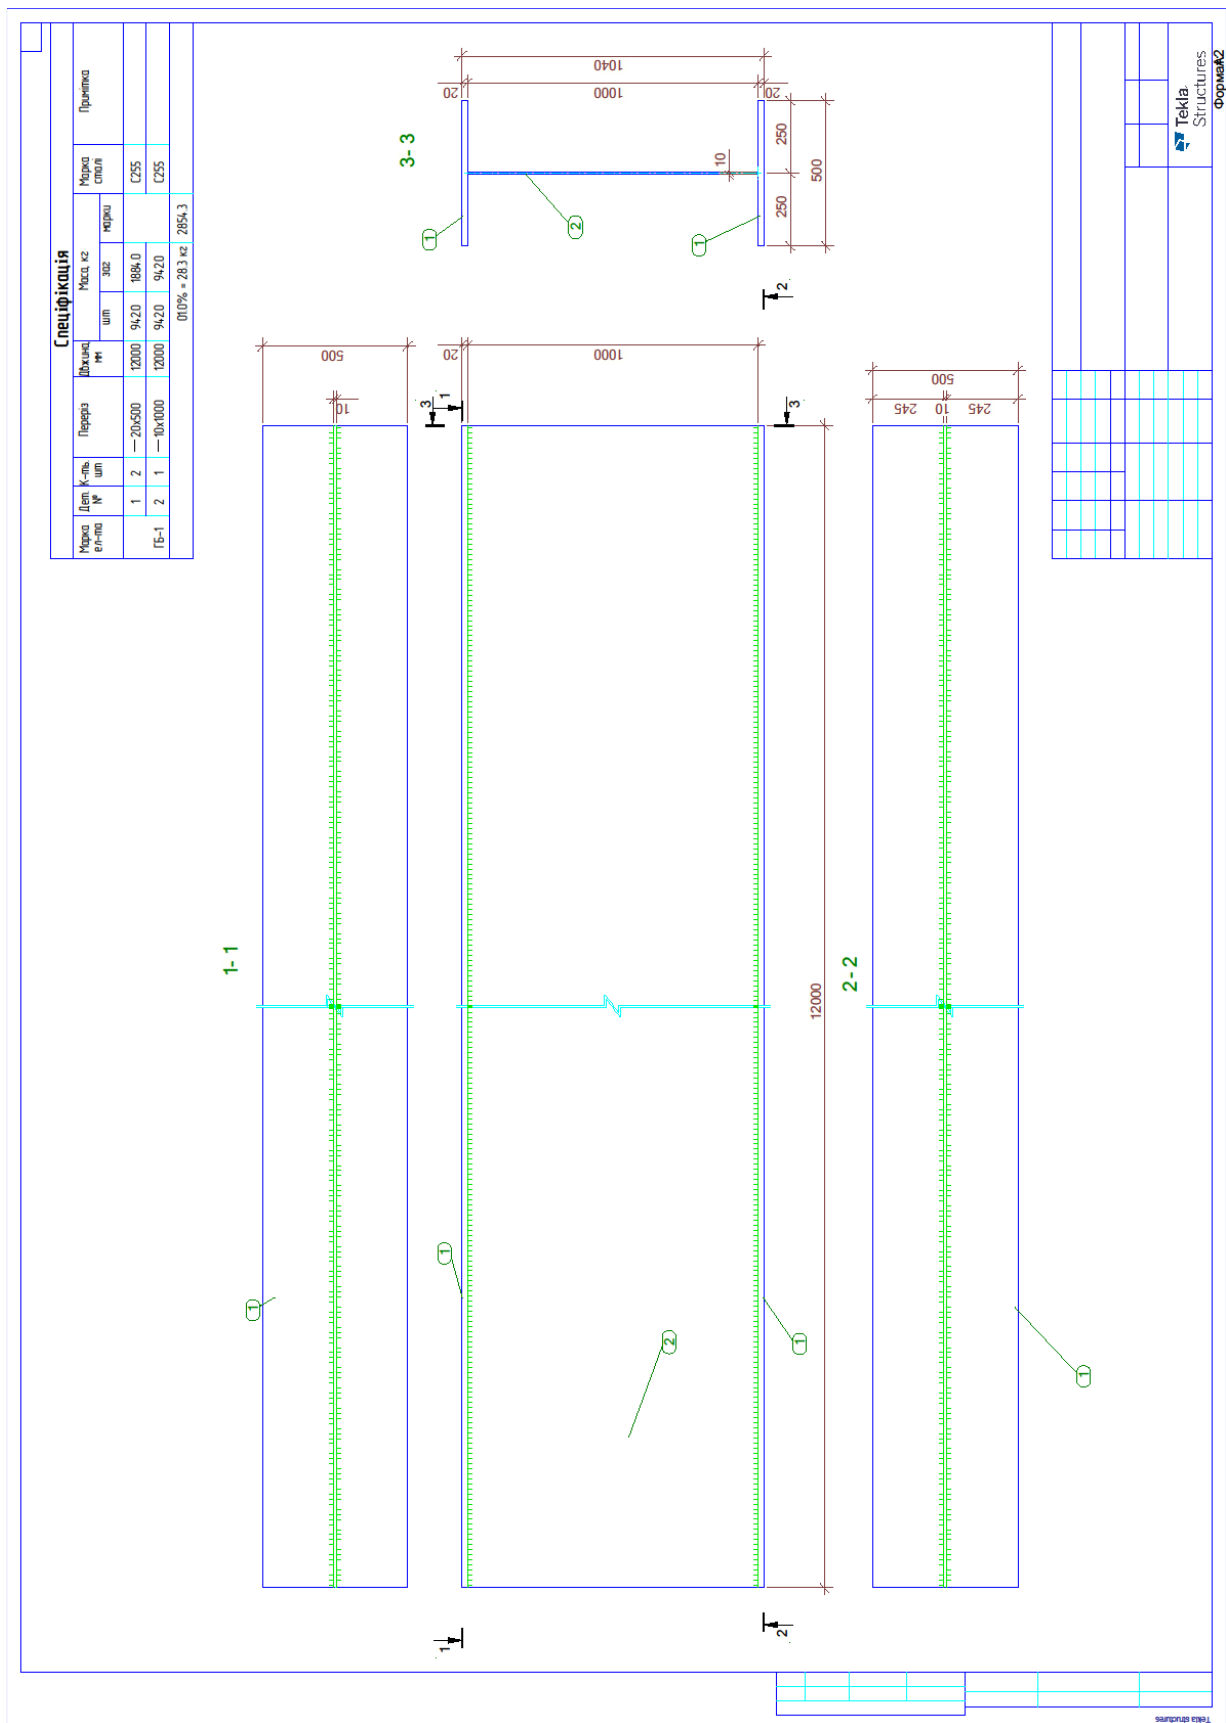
Креслення стадії розробки «Конструкції металеві деталювальні»
